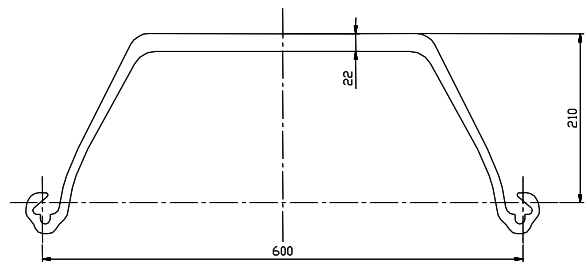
溝付き継手鋼矢板の断面図（単位: mm）
